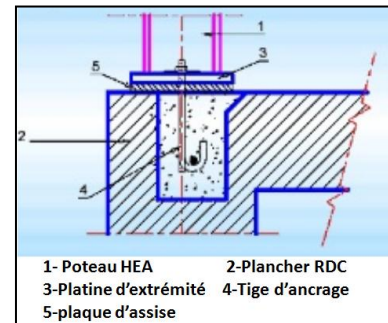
Détail n°01: Articulation pied de poteau- fondation Source : Auteurs
